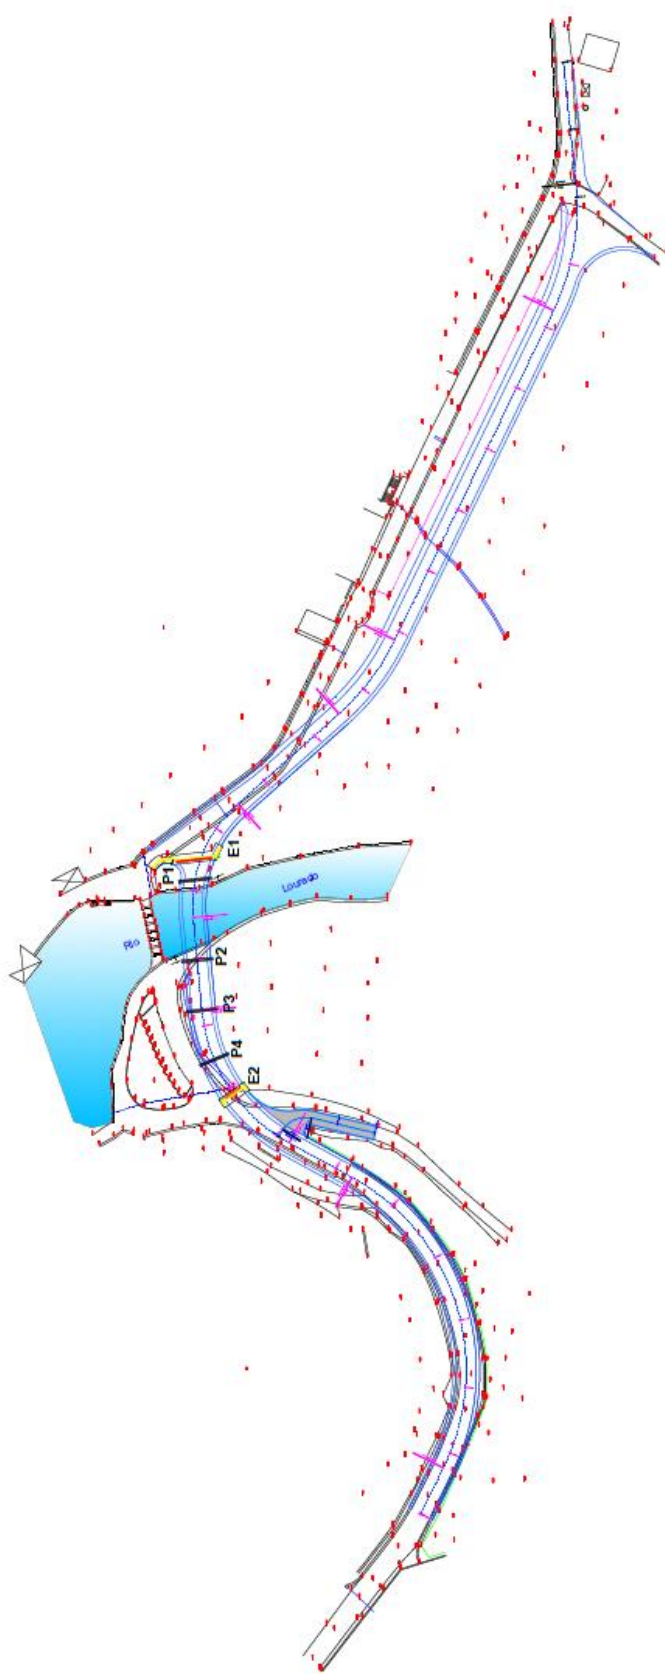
Planta de fundações da ponte sobre o rio Louredo. 2ª localização aconselhada.
